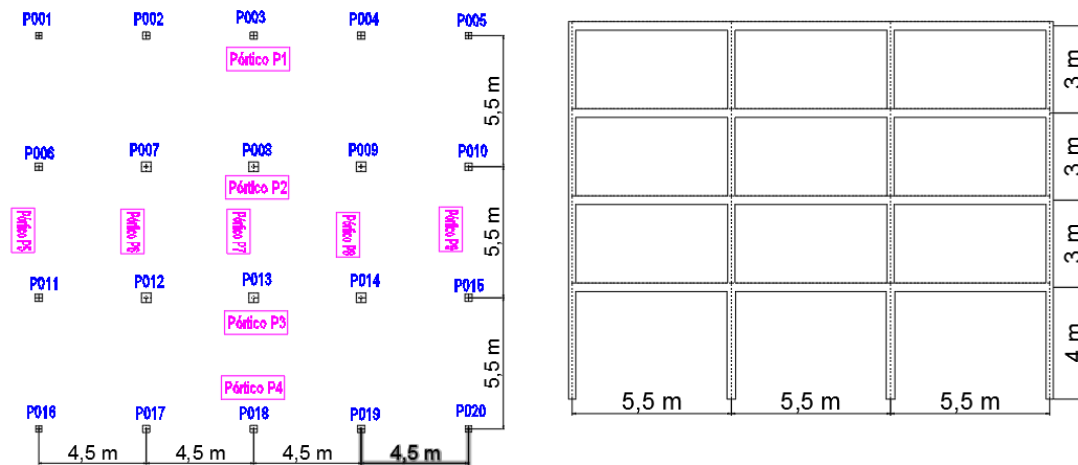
Vista en planta de pilares y pórticos (izquierda). Vista en alzado pórtico 5 (derecha). Vistas incluidas en el plano 1,3 y 4 del Anexo I.
